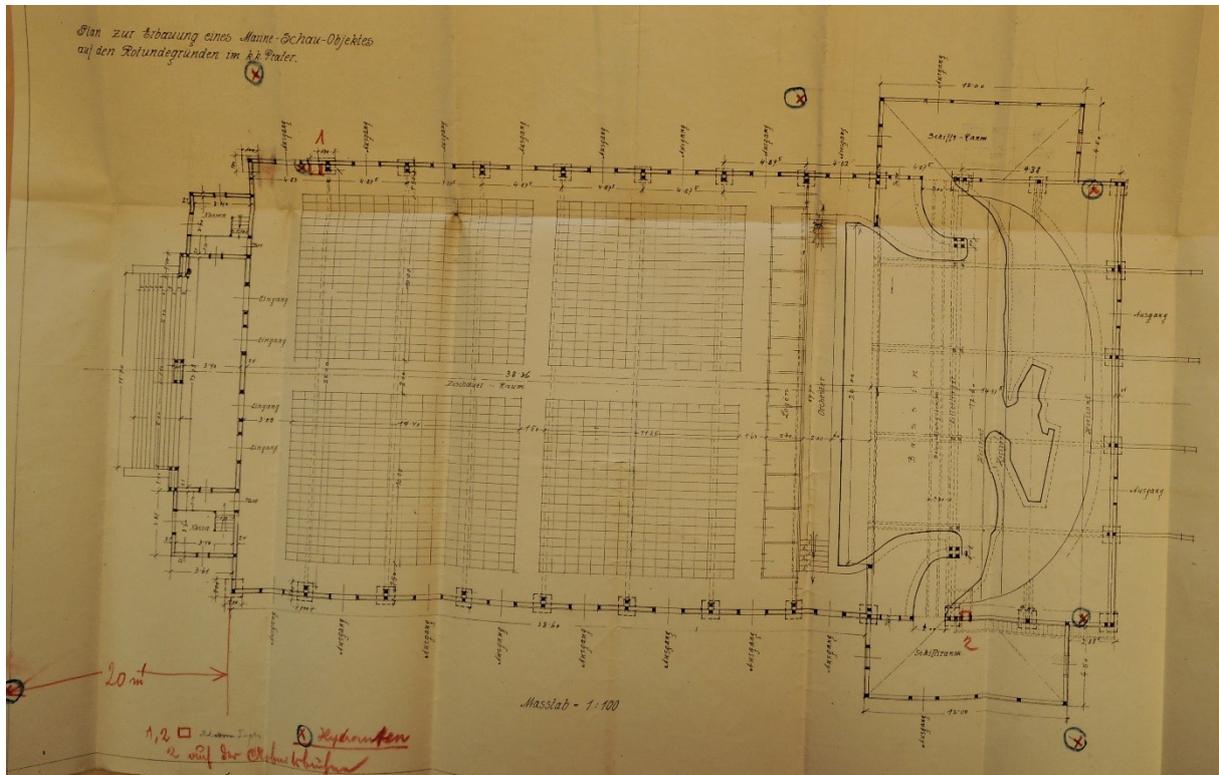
Grundriss des 1916 auf den Rotundegründen errichteten Gebäudes für die Marineschauspiele
